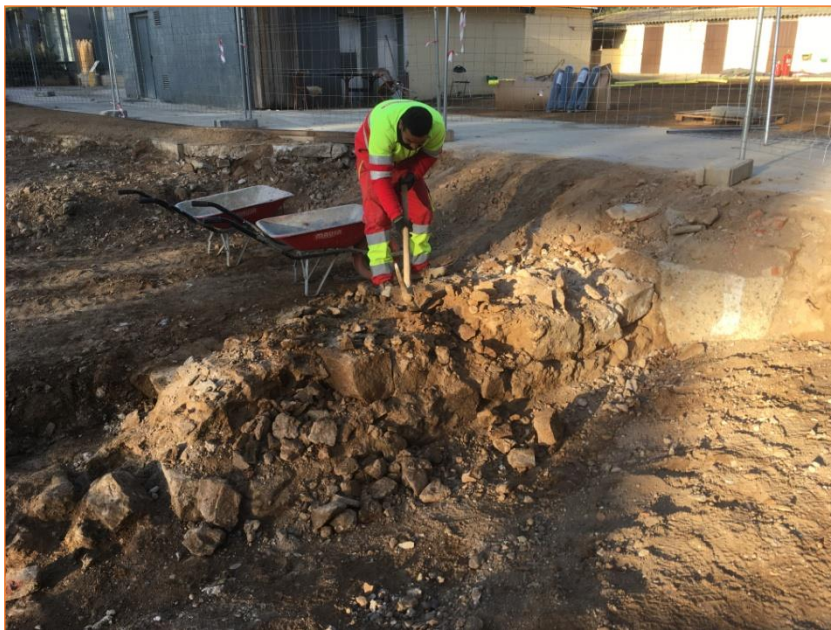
Vista dels treballs de desmuntatge del nord-est del mur UE 25.
